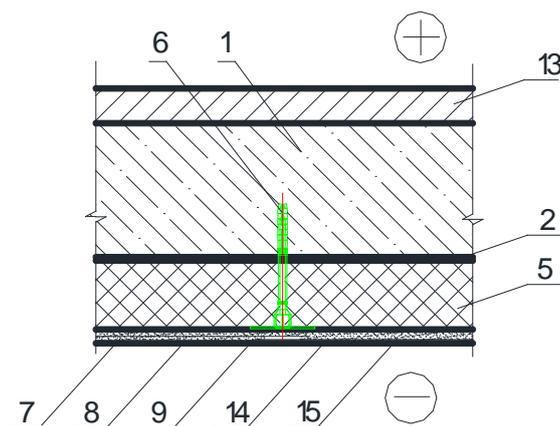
Розрахункова схема утепленого покриття: 1 - основа – залізобетонна плита перекриття - 220 мм; 2 - адгезійна грунтовка - ґрунтувальна суміш Ceresit СТ 17 та клейовий шар для приклеювання плит утеплювача до основи, а також для вирівнювання поверхні основи - суха цементно- піщана суміш Ceresit СТ 190 - 10 мм; 5 - теплоізоляційний шар - мінеральна вата IZOVAT 135 – 200 мм; 6 - елементи кріплення теплоізоляційних матеріалів - полімерні дюбелі із сердечником з нержавіючої сталі; 8 - армуючий штукатурний шар - суха цементно- піщана суміш Ceresit СТ 190 - 3мм; 7 - армуюча сітка - Saratect-Gewebe 650/110 із нахльостом 100мм - 0,5мм; 9 - другий штукатурний шар - суха цементно- піщана суміш Ceresit СТ 190 - 5мм; 13 - бетонна підлога – 80 мм; 14 - декоративно-захисне покриття - Ceresit СТ 73 - 5мм; 15 - фарбування - 2 шари силіконовою фарбою Ceresit СТ 48 - 0,5мм.
